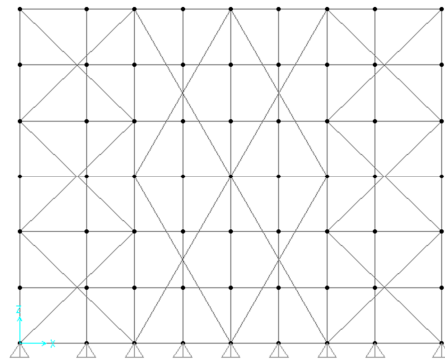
Configuração dos Planos de Contraventamento Vertical Com Elementos de Contraventamento Grandes
